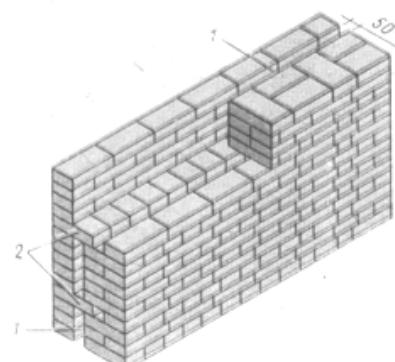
Кладка с воздушной прослойкой: 1 – воздушные зазоры; 2 – перевязка тычками
